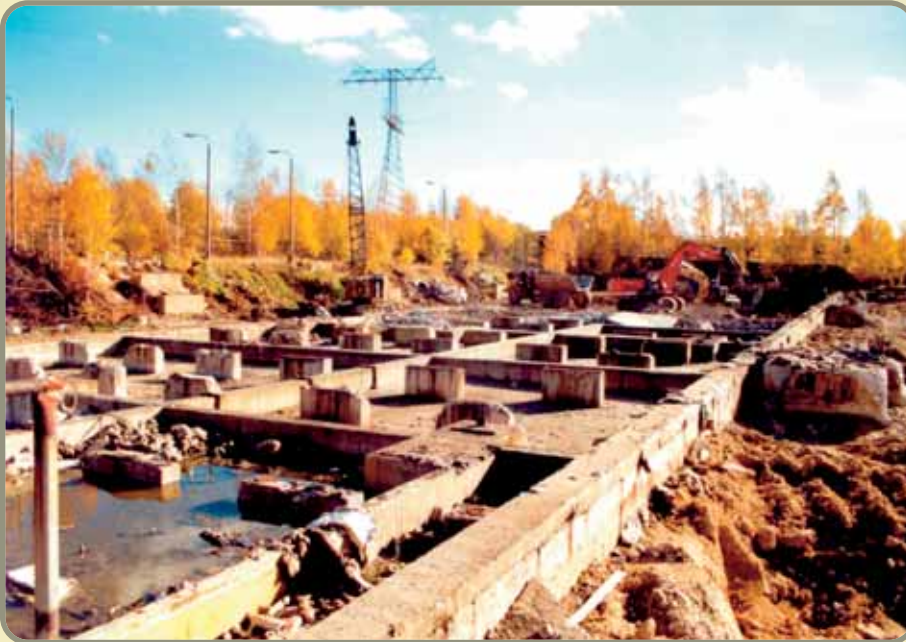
Auffangwannen und Fundamente im Tanklagerbereich beim Rückbau
